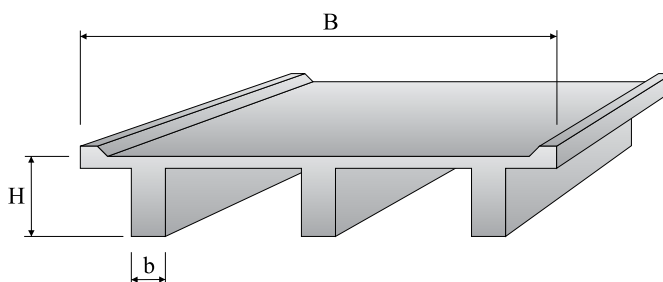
Bjelkebru med T-bjelker i betong
